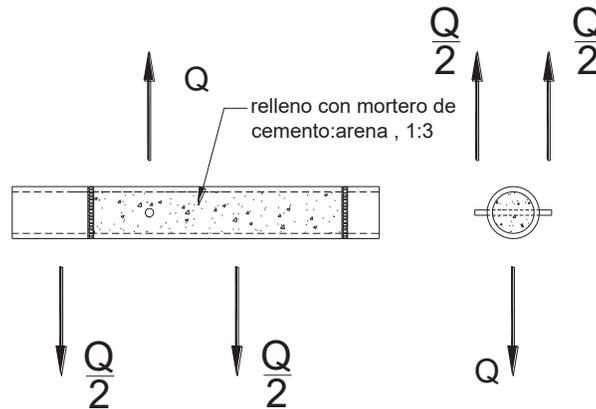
Unión de bambú con cargas a tensión perpendiculares a la fibra, tipo Q.
